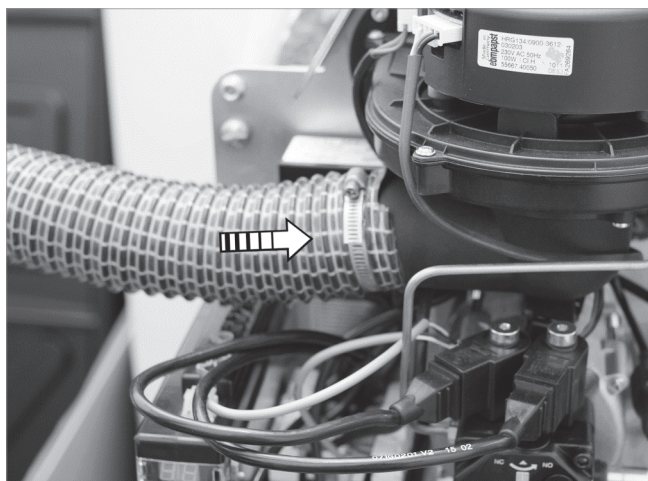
Fixation du tuyau d'amenée d'air sur la soufflante
